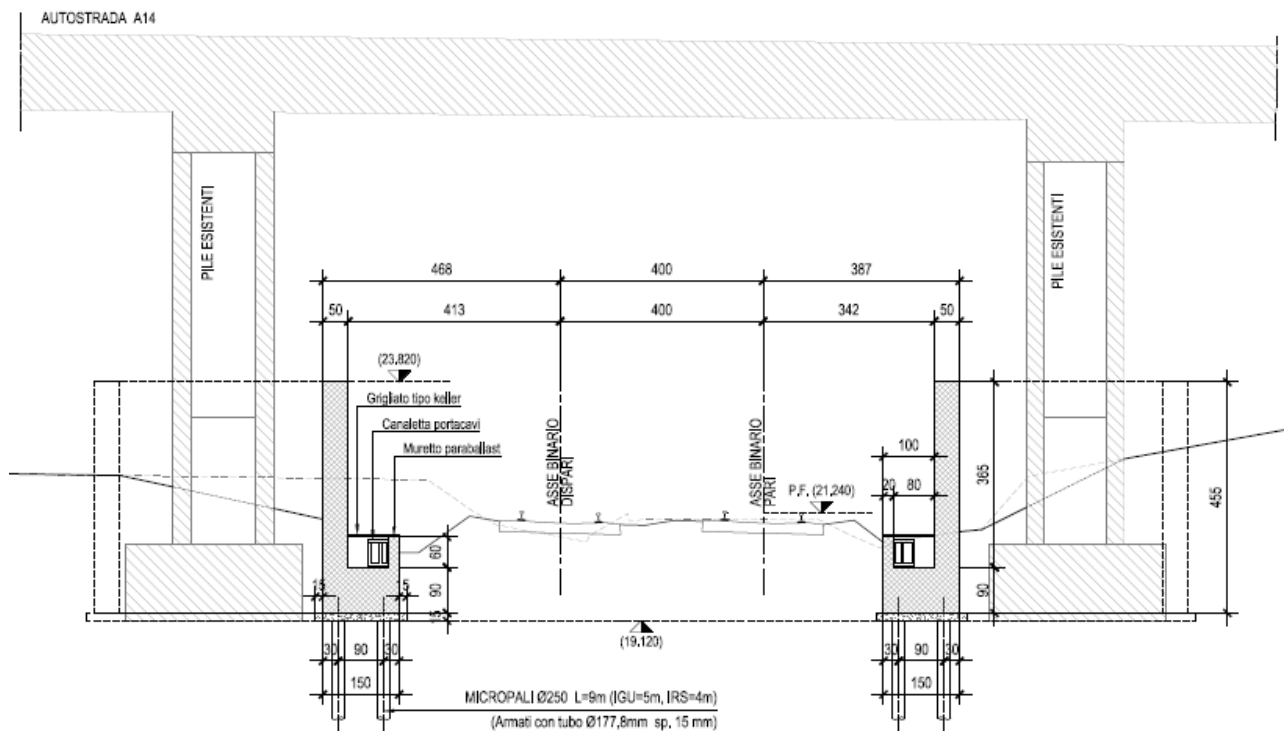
Opere di protezione CVF Autostrada A14 - Sezione Trasversale
